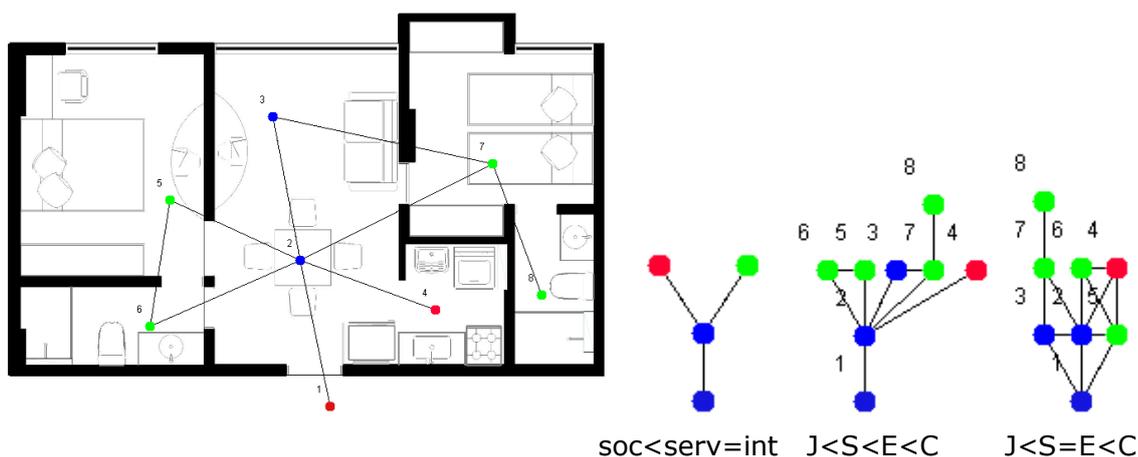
| Park Royal 1 (2009). Fonte: elaborado pela autora.
